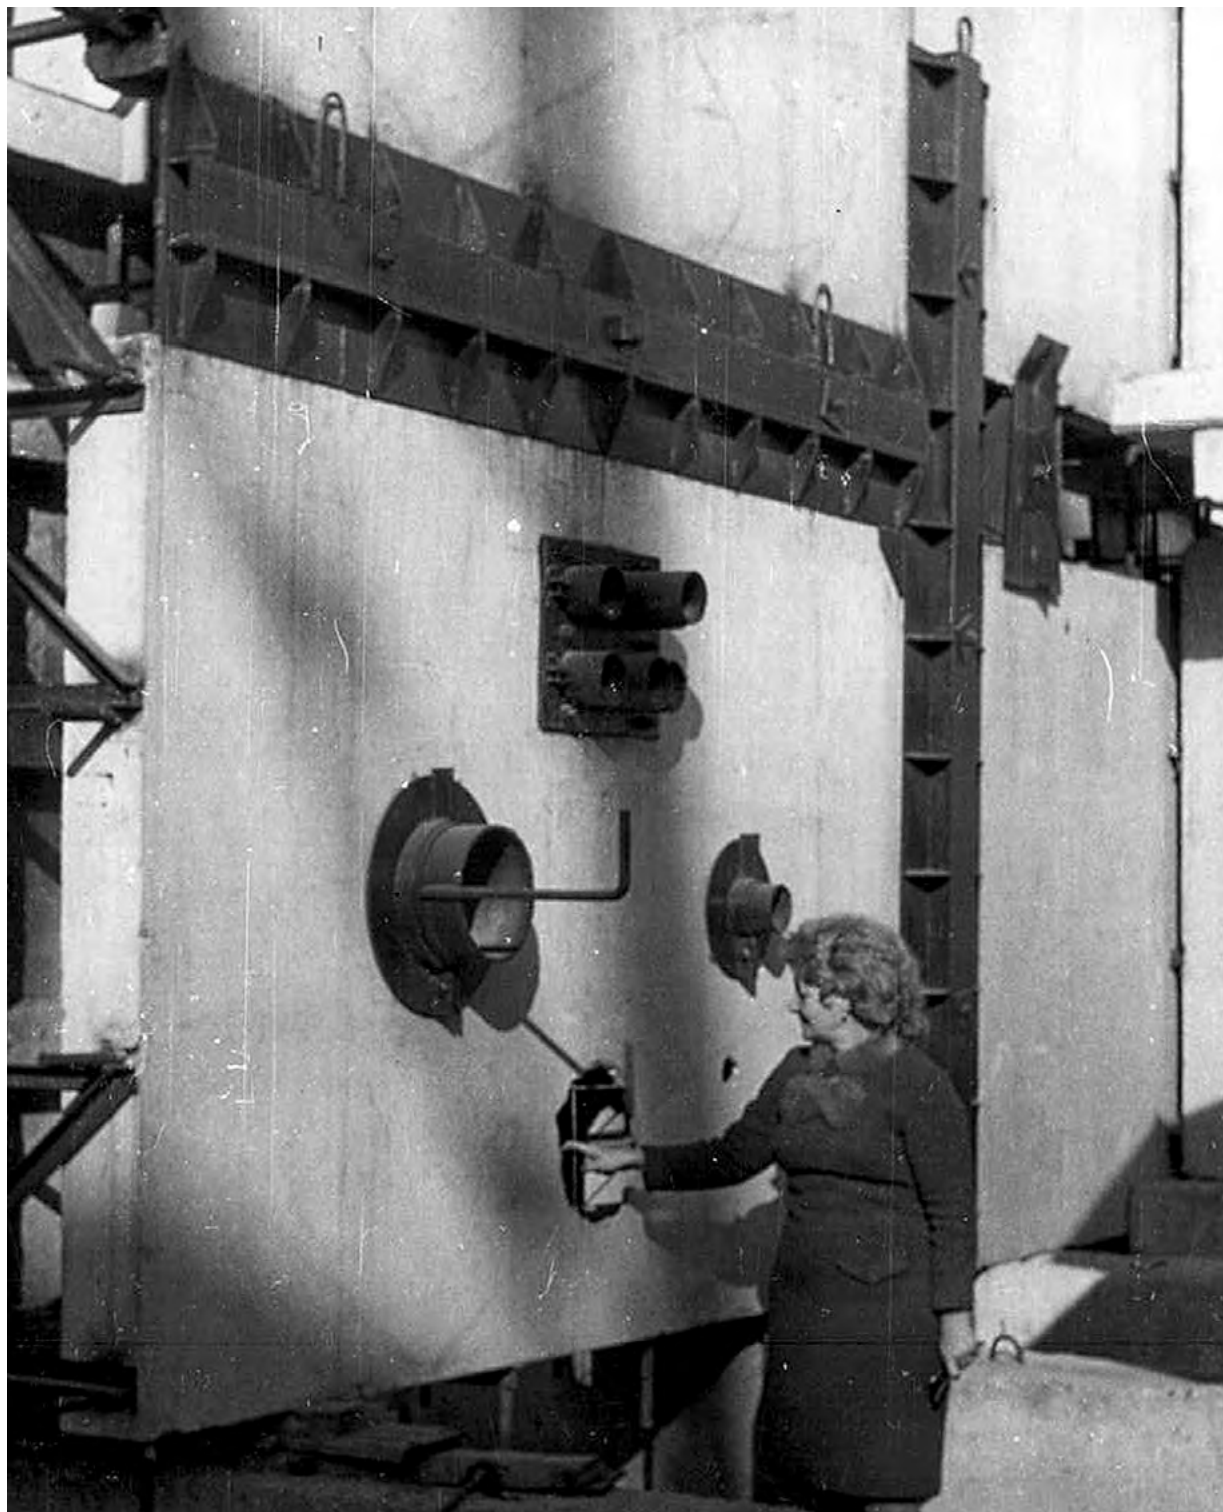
Объединение плит в пространственный стеновой блок (ребрами внутрь) путем приварки к арматурным выпускам по торцам плит связей из уголков (показаны установленные проходки и отверстие под них)
